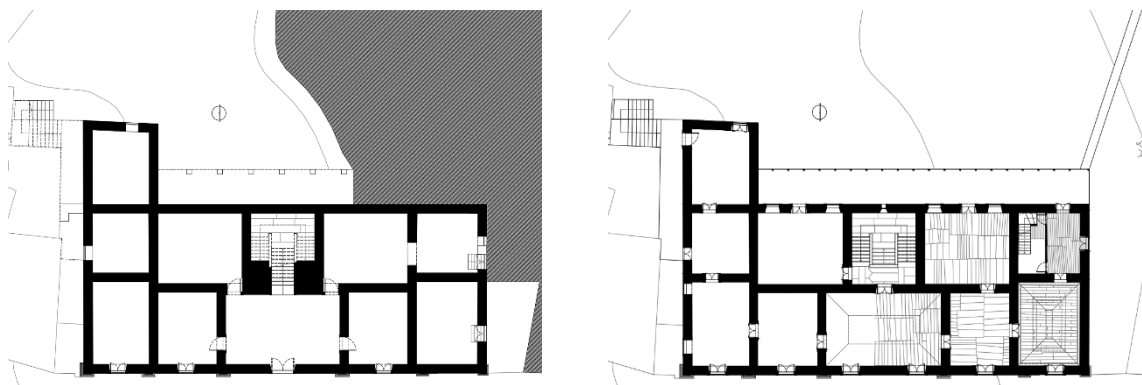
Planta hipotética Piso Térreo e Piso 1
